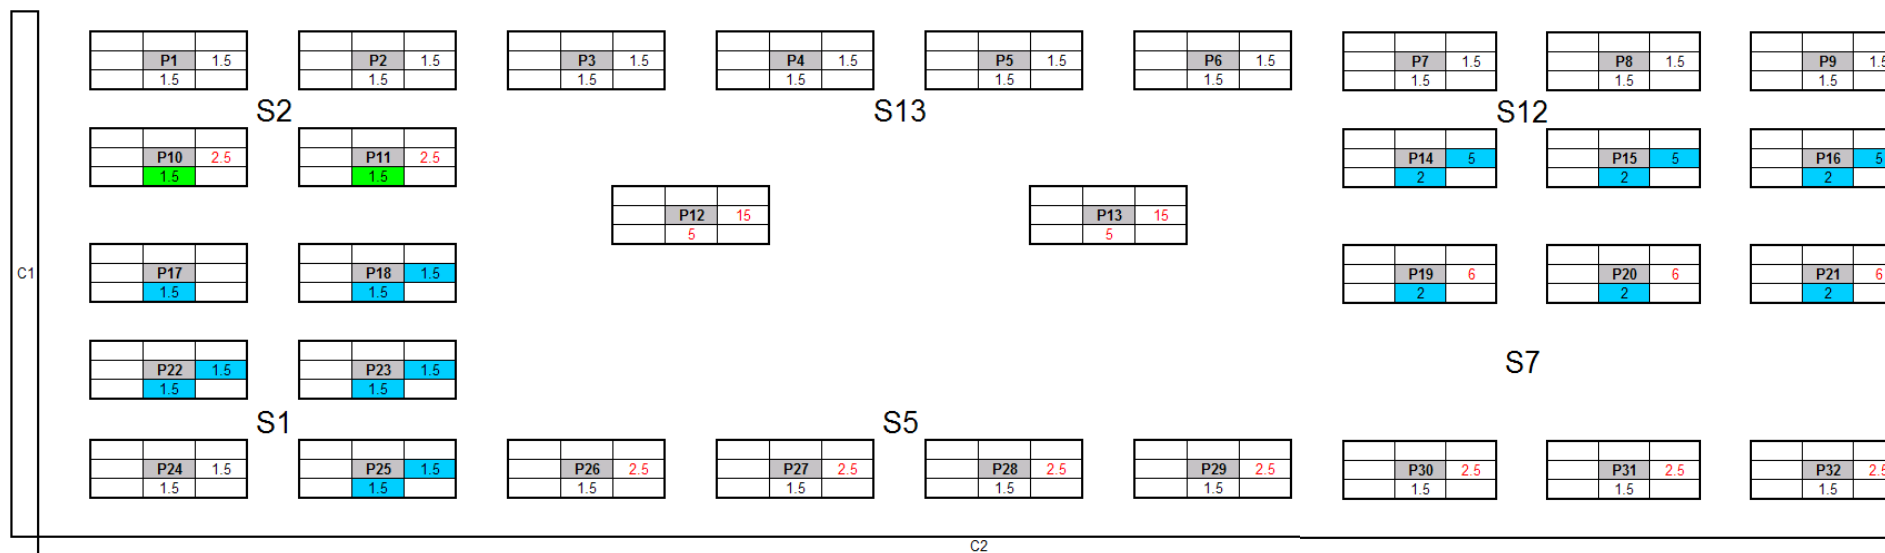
Planta esquemática e dimensões finais das sapatas de fundação (panorama final).
